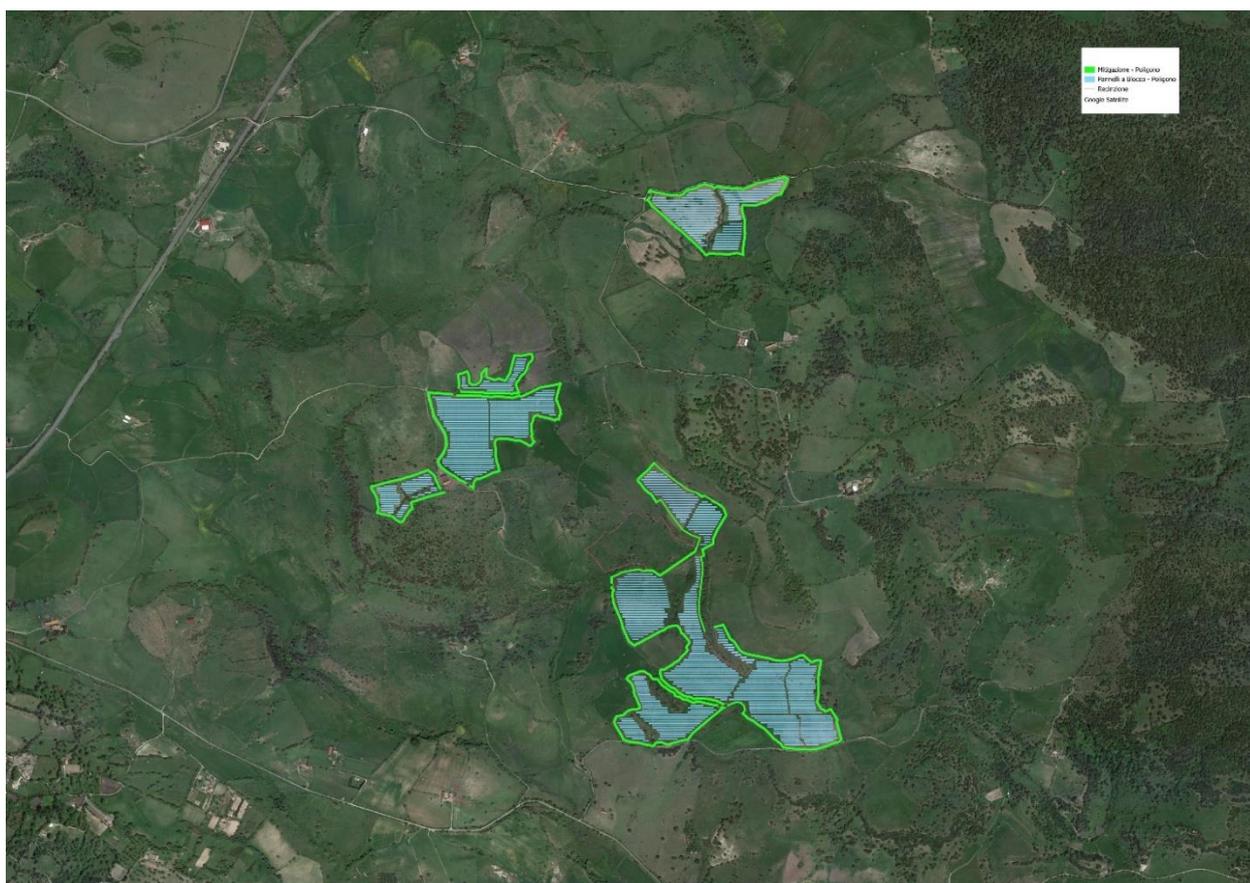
Stralcio planimetrico – Layout e misure di mitigazione
